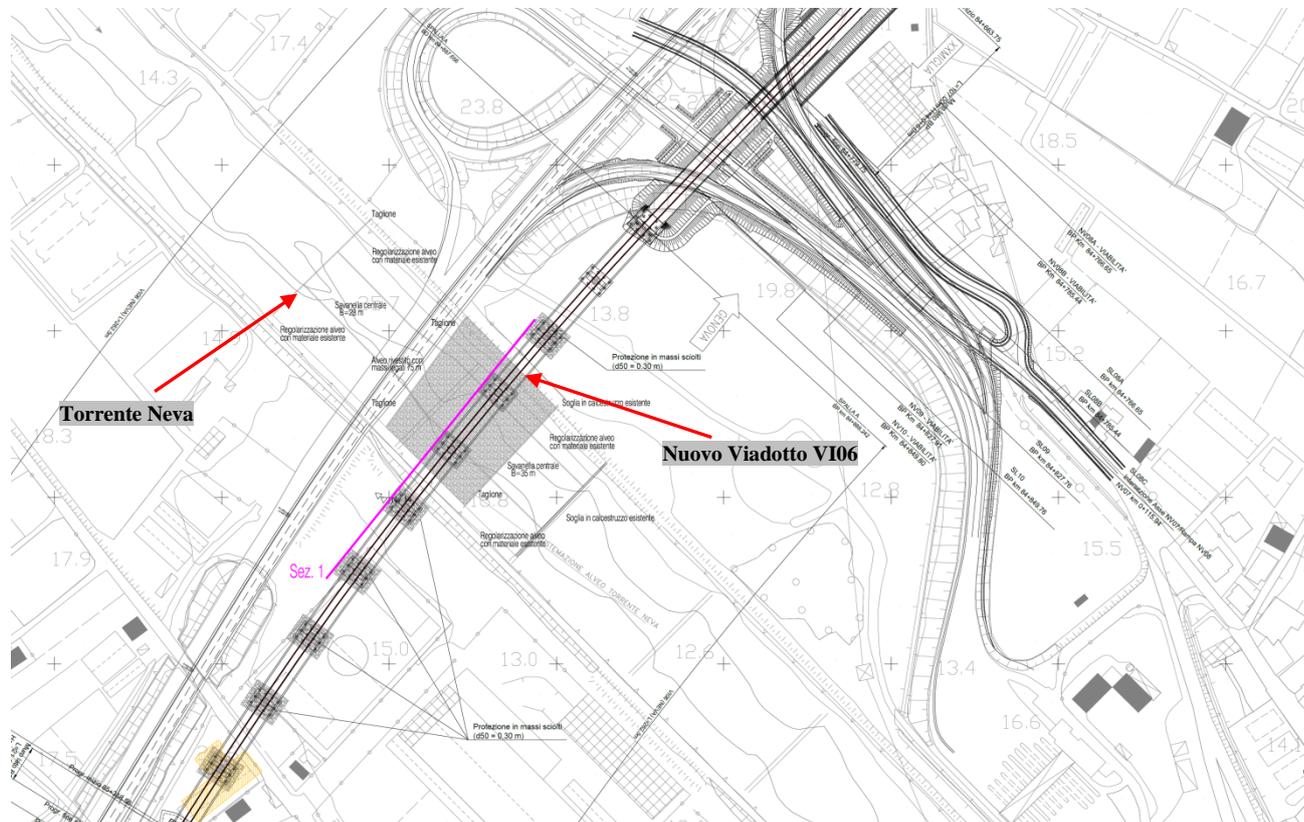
Stralcio della planimetria di progetto in quel di Albenga (attraversamento del Torrente Neva).
